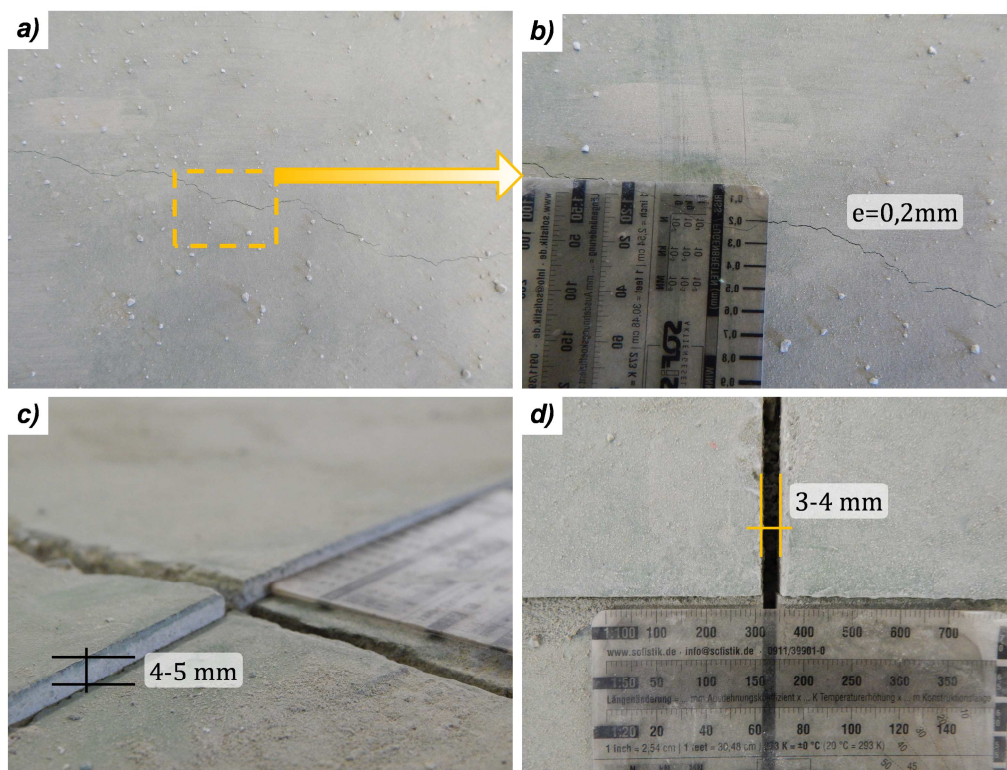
95 – Lesiones; a) fisura de retracción; b) ampliación de la fisura en “a”; c) escalón entre losas contiguas; d) junta de corte transversal
